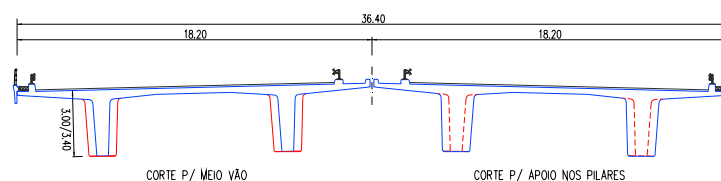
Secções transversais dos tabuleiros em laje vigada.
